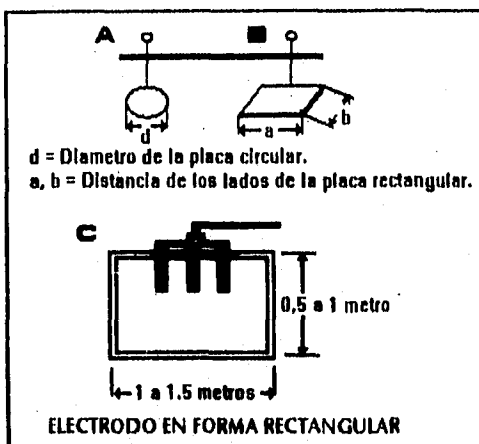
Electrodo en forma de placa circular (A) y Rectangular (B), forma de conectar una placa rectangular con la línea de enlace a tierra utilizando soldadura de alto punto de fusión (C).
